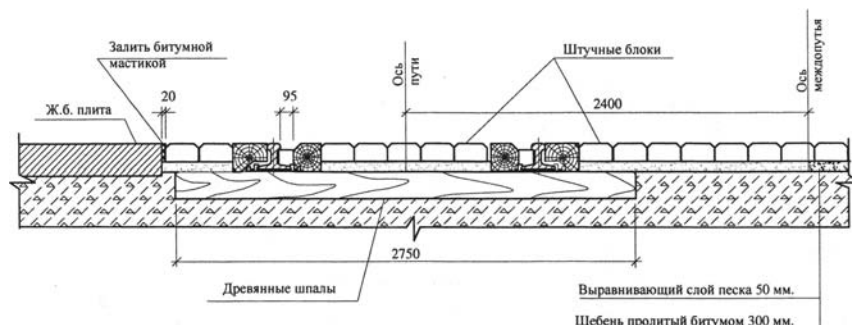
Конструкция железнодорожного переезда и устройство дорожного покрытия в районе железнодорожных путей с использованием камней мощения.
